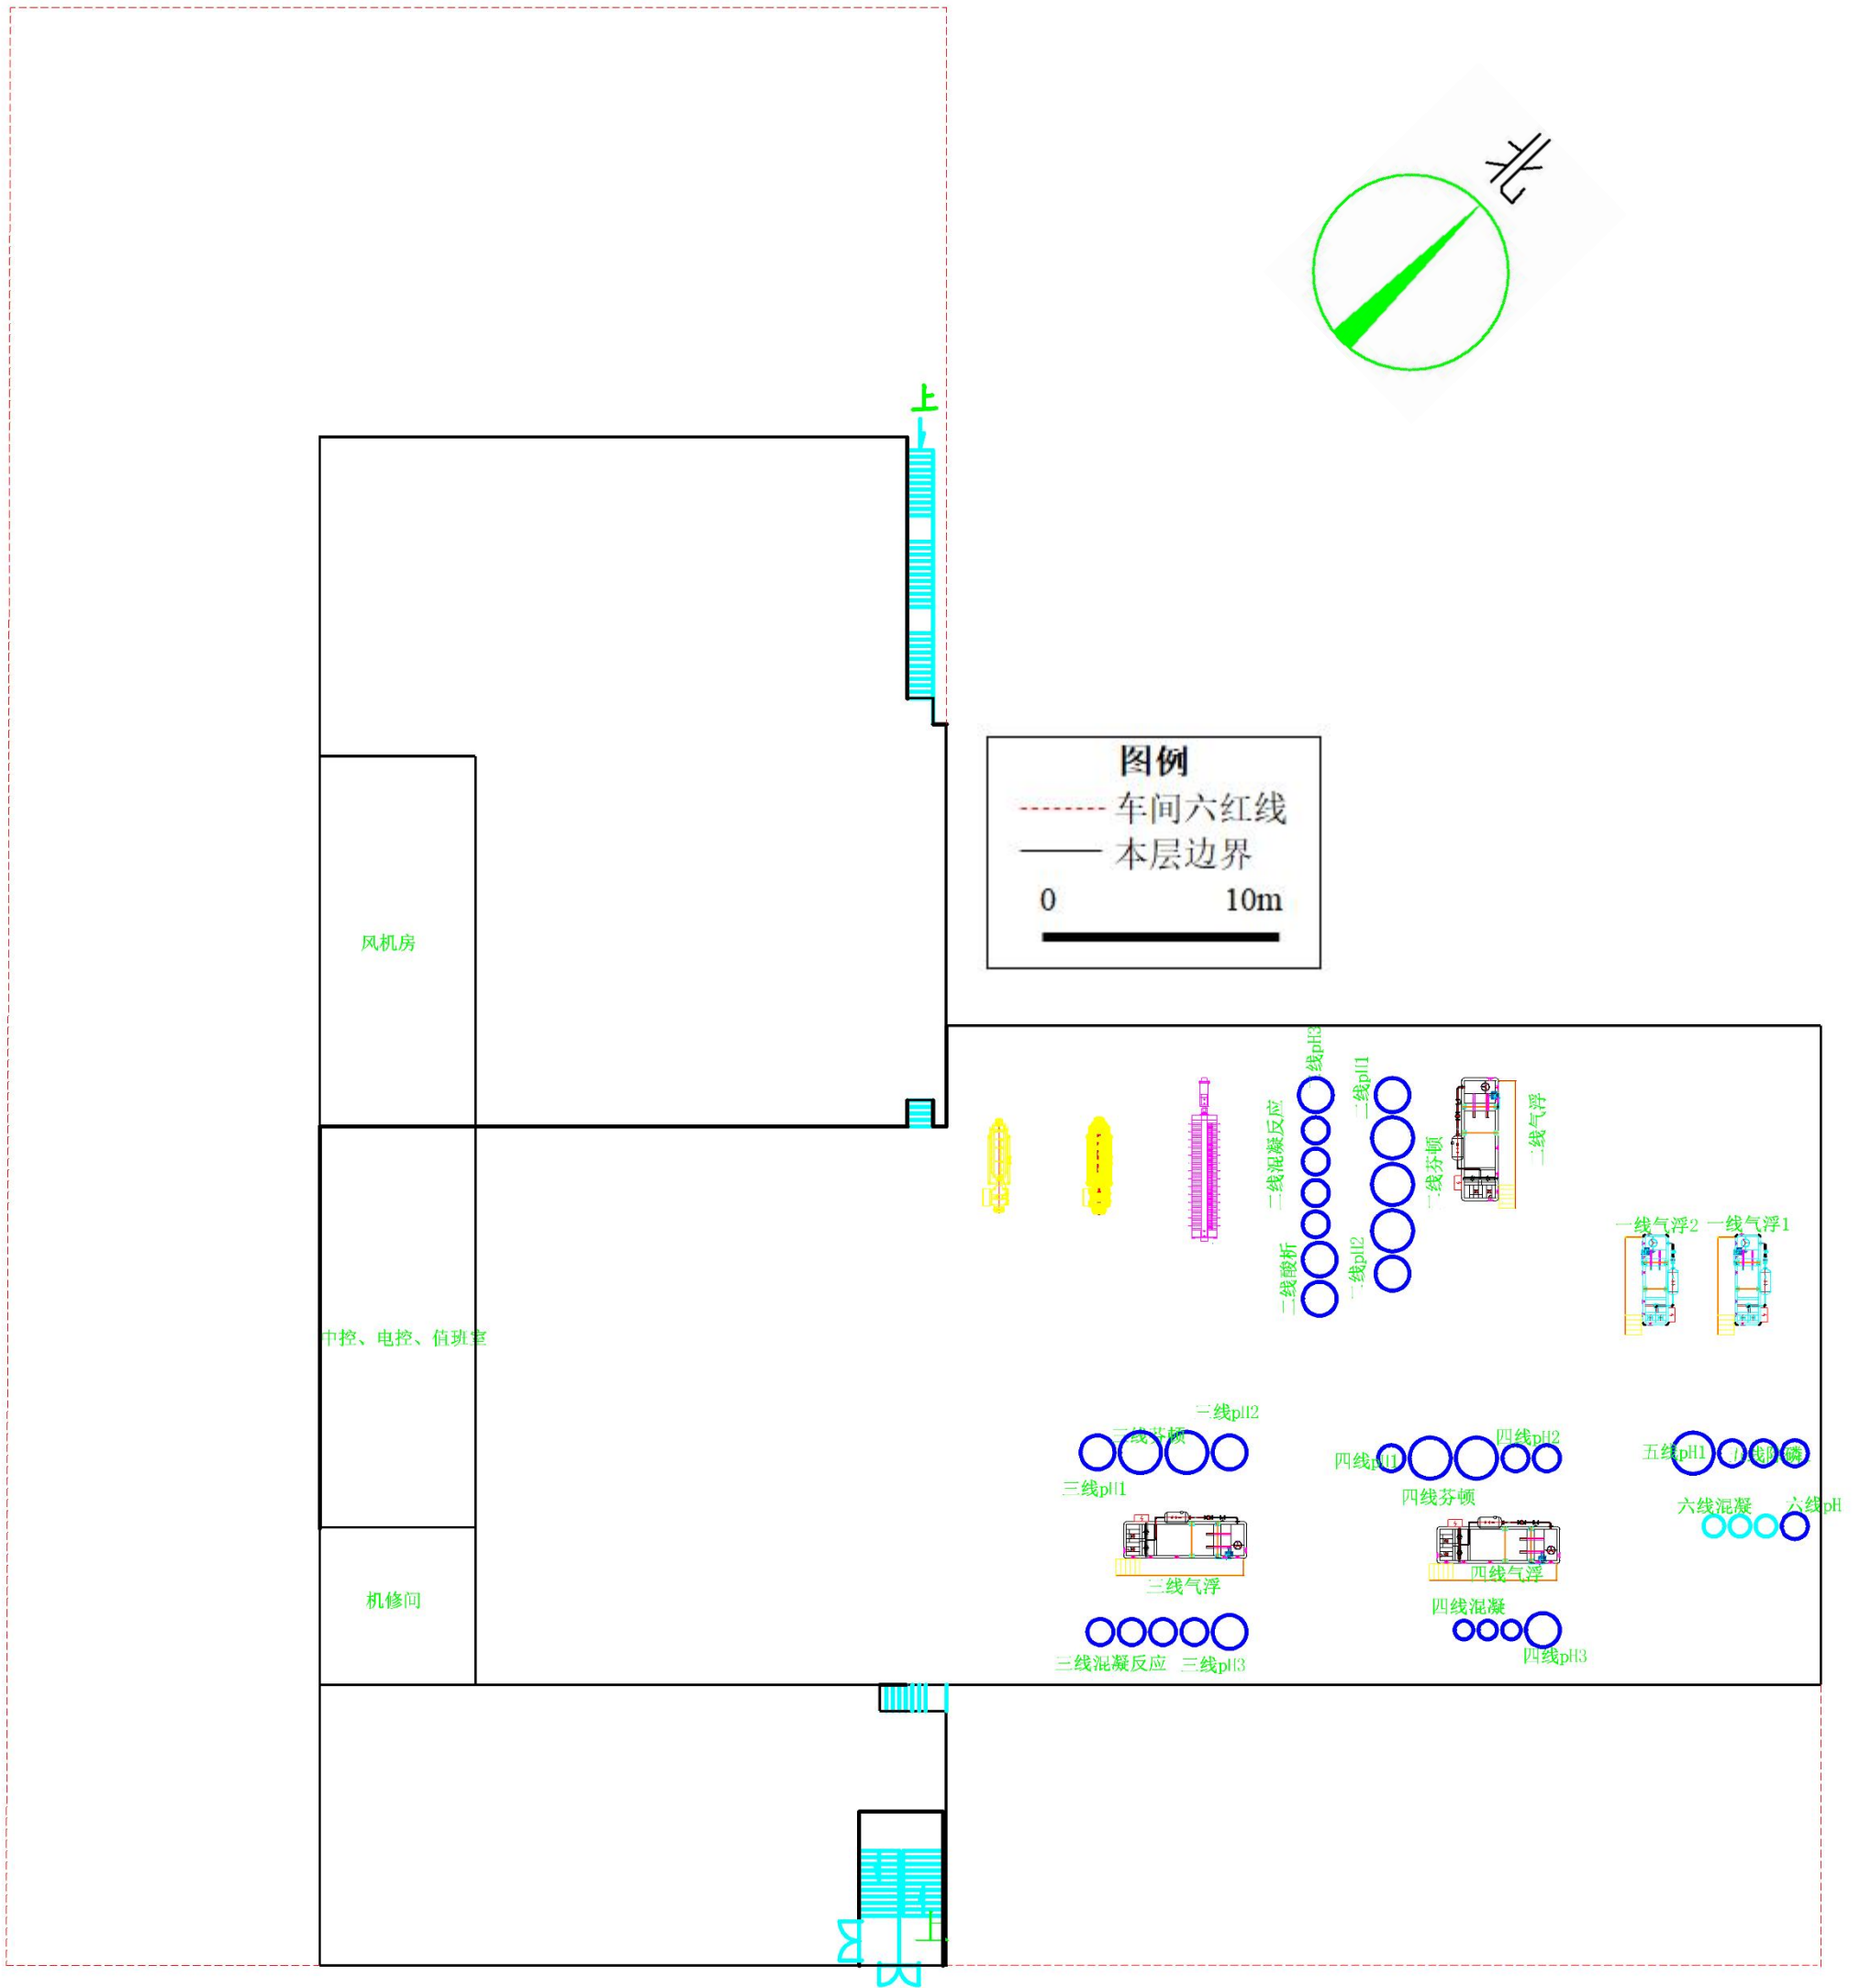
(b) 污水处理车间总平面图 (二层)
